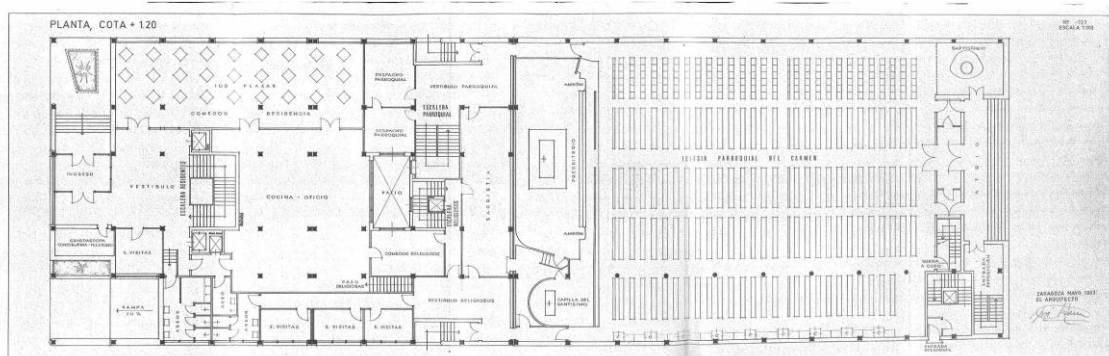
Configuración en Planta Baja en el proyecto de Mayo de 1963
